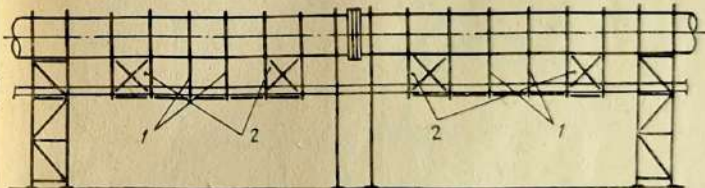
Пример связевой системы для подвески трубопроводов:
